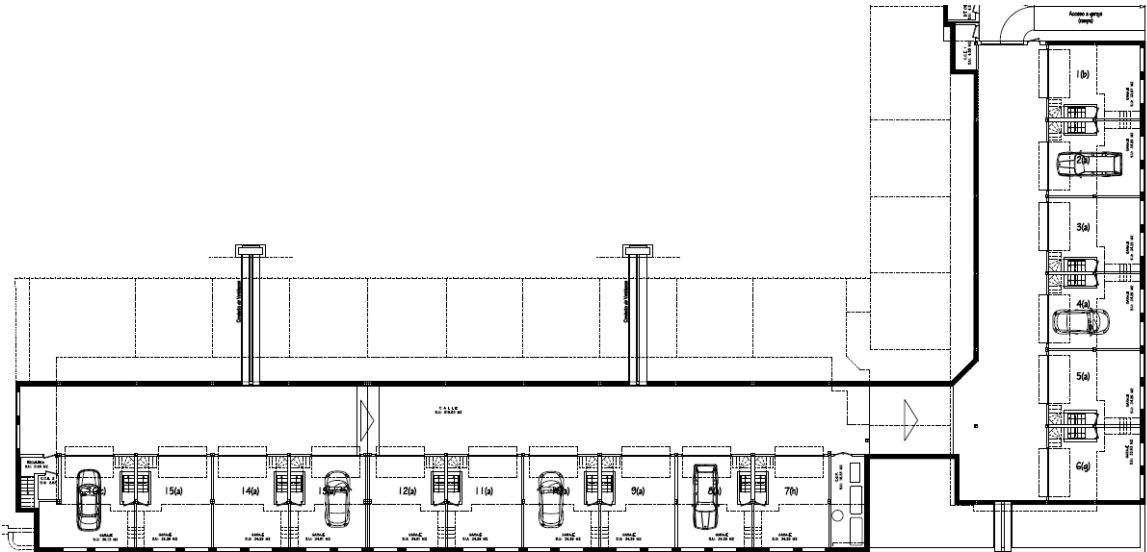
Planta sótano del Bloque 1 de la Manzana R1. Huerta de Enmedio
